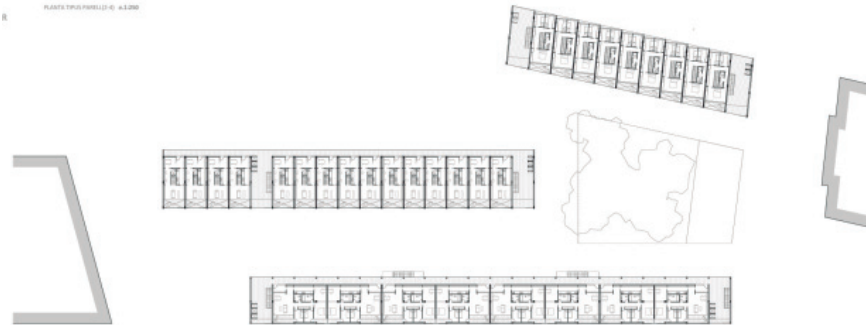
Ejercicio 2. Planteamiento urbano y planta tipo
